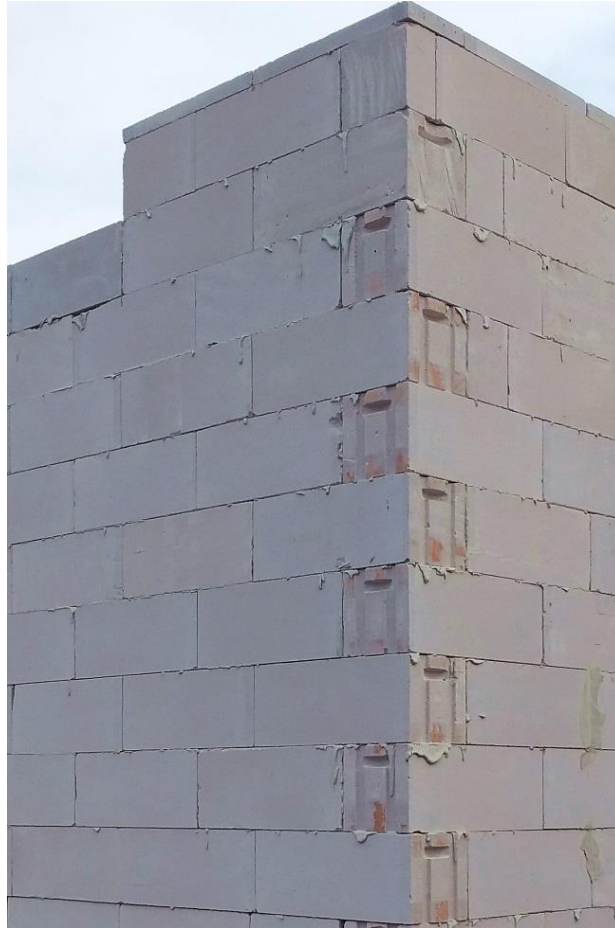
Colocación del bloque de hormigón celular en esquina. Fuente: elaboración propia.
